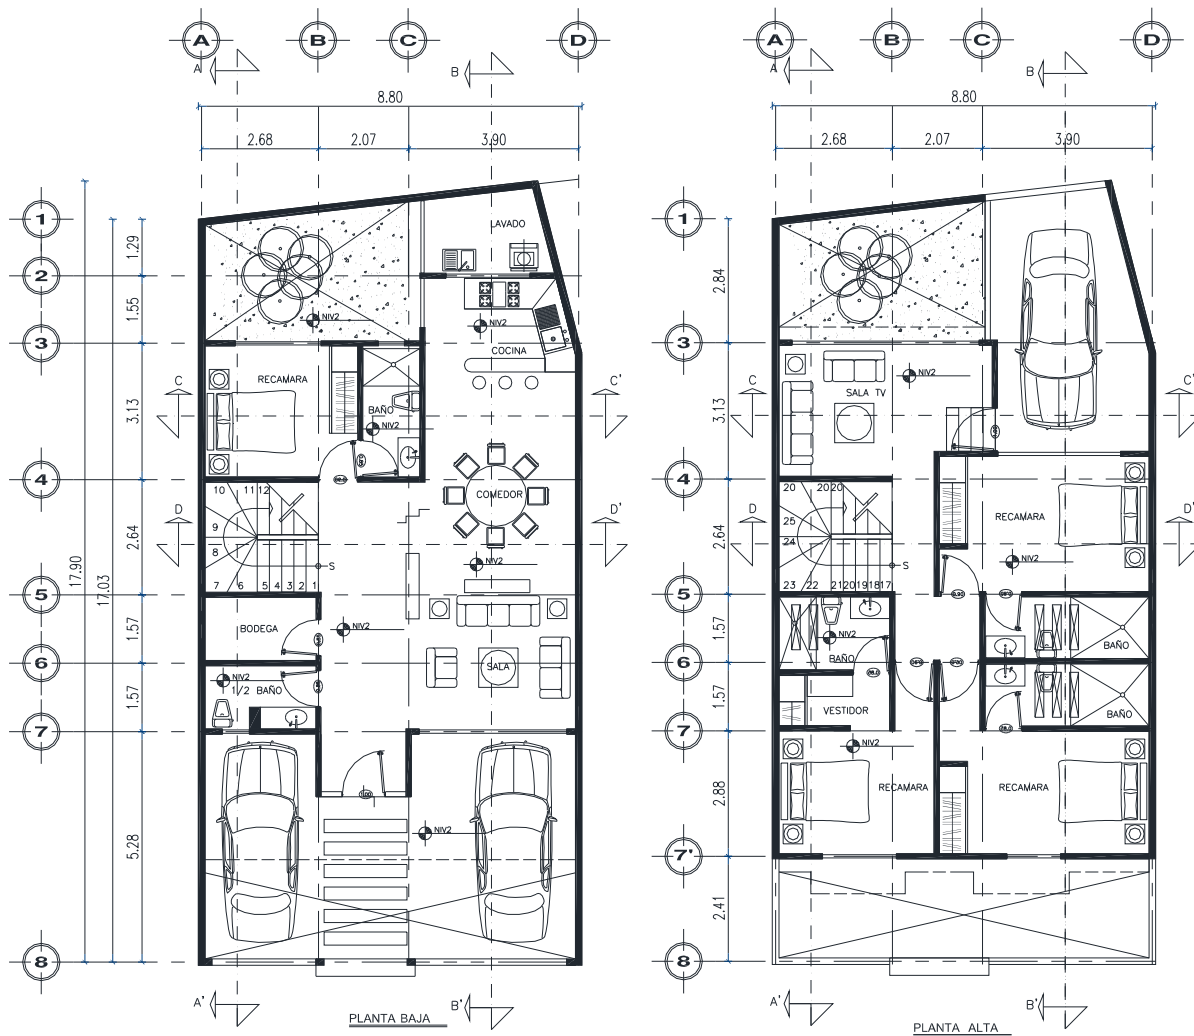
Plantas arquitectónicas (Dimensiones en metros).
